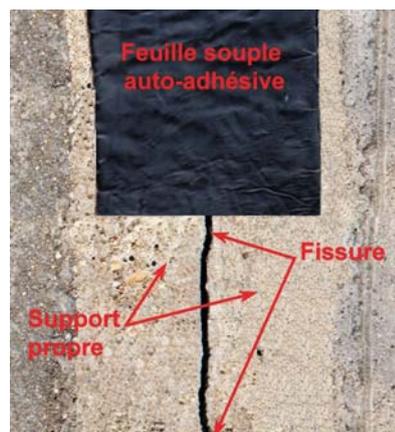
mise en place d'une feuille auto-adhésive (photomontage Poineau)
